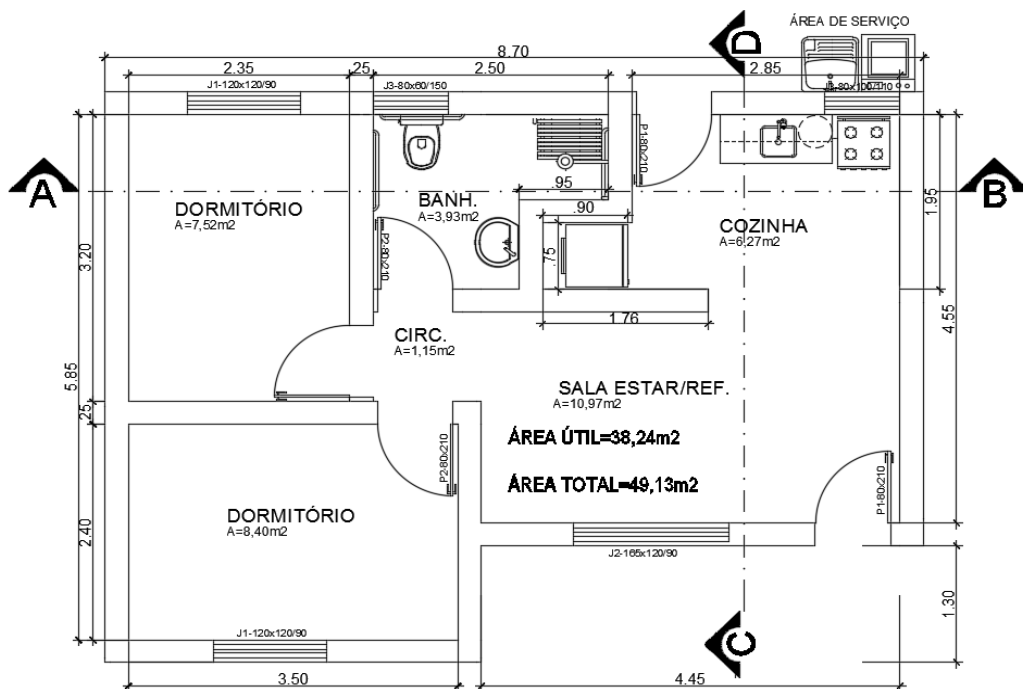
Planta baixa modificada. Fonte: Autoria Própria
